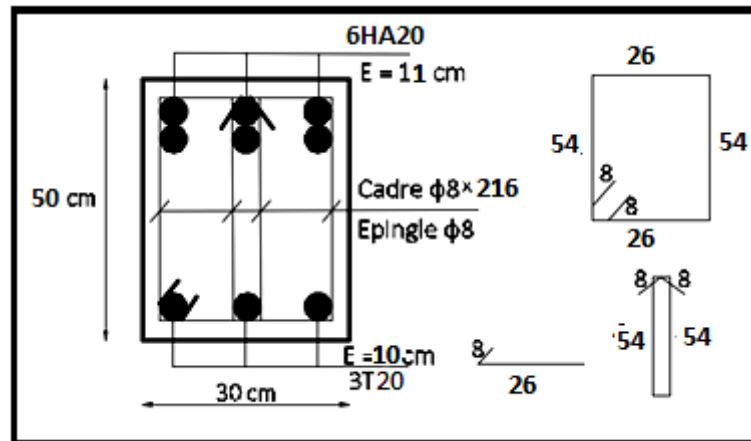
Dessin de ferrailage de la poutre principale en appui.
